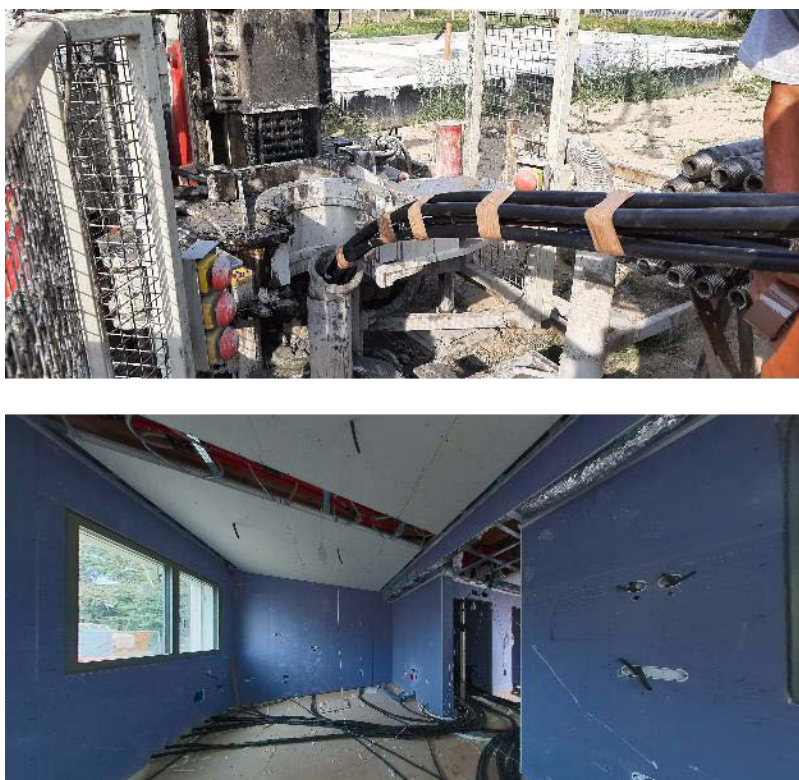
(sopra) Esecuzione delle sonde geotermiche; (sotto) allestimenti impiantistici generali e riscaldamento a soffitto.
